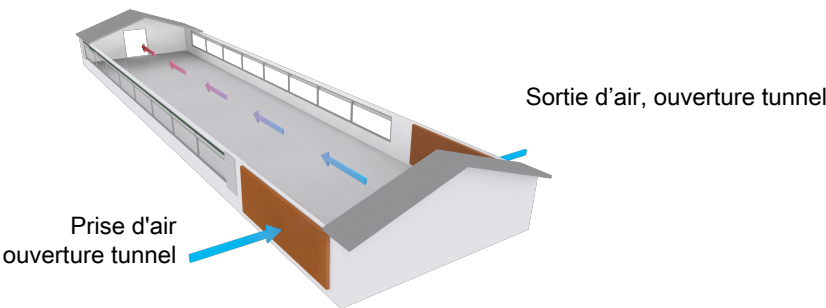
Exemple de bâtiment d'élevage avec la ventilation naturelle en association avec la ventilation tunnel, Ventilation tunnel.
